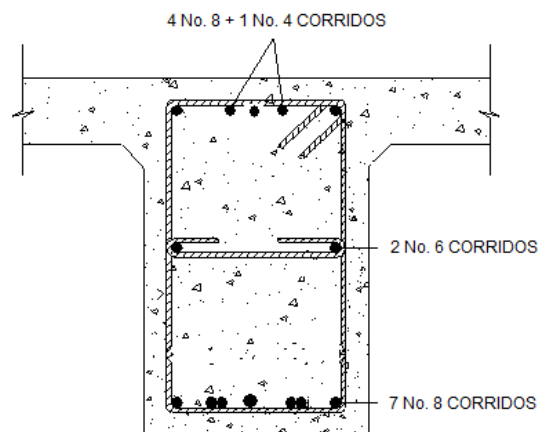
Detalle de refuerzo viga externa a 2.75 m del apoyo
